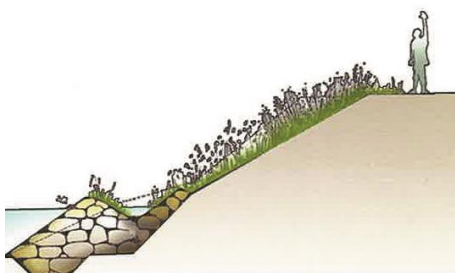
Placette publique, accessibilité et reprofilage de berges
